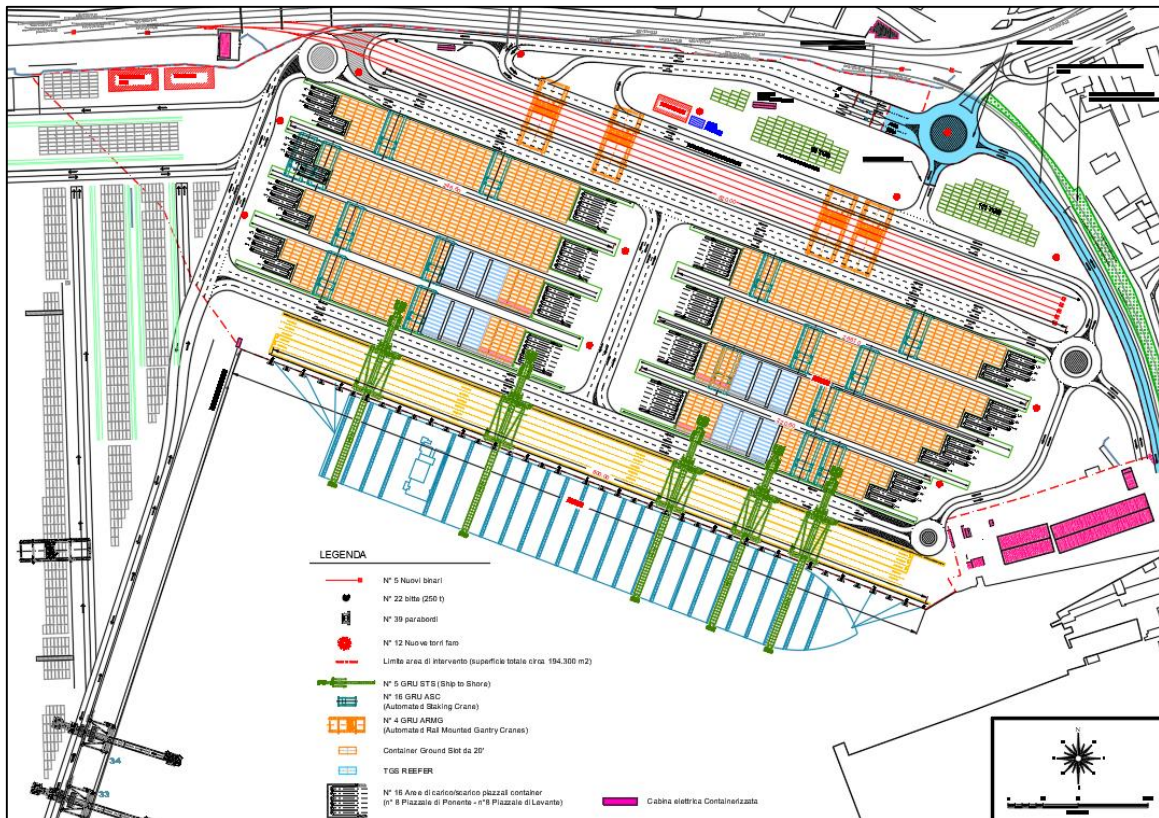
PFTE 2022 Nuovo terminal Ravano - Planimetria di progetto
